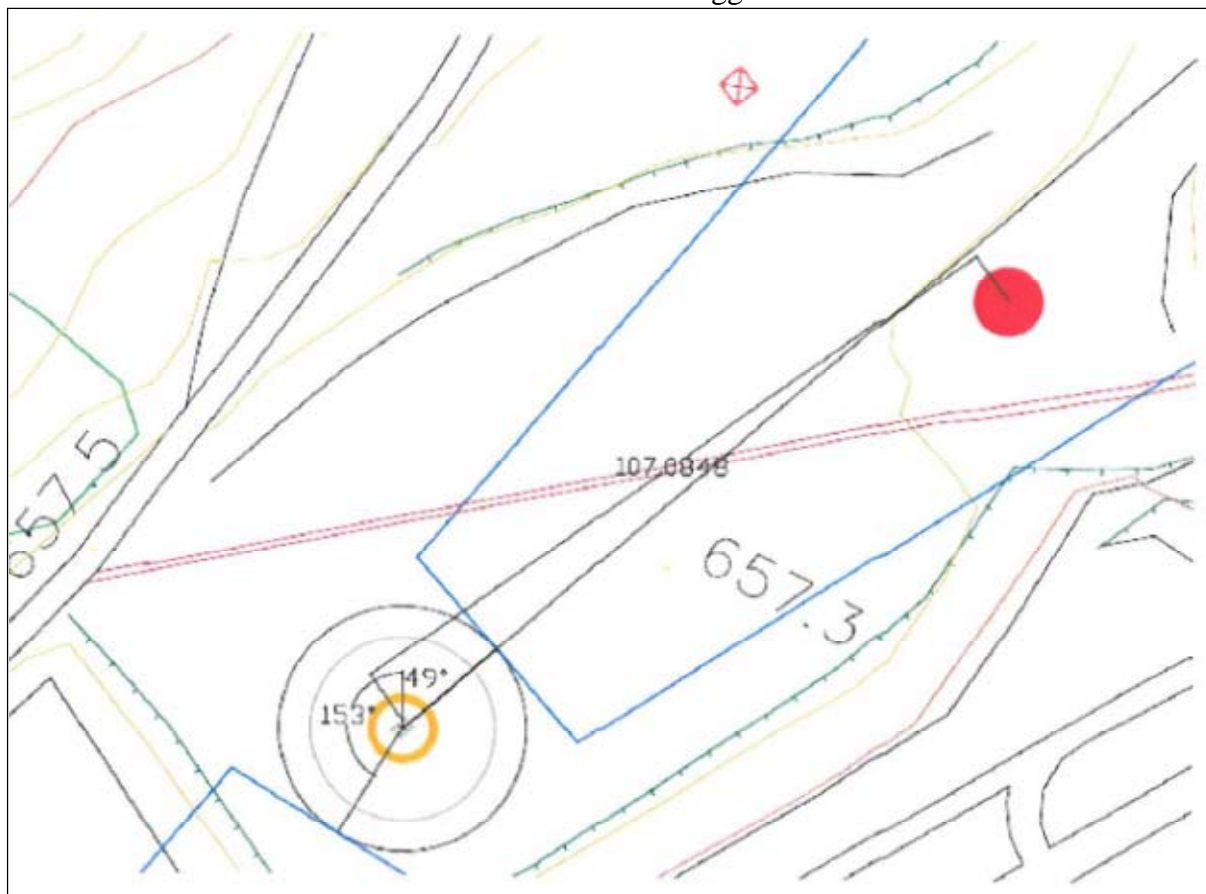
Planimetria con individuazione delle direzioni di decollo e atterraggio
